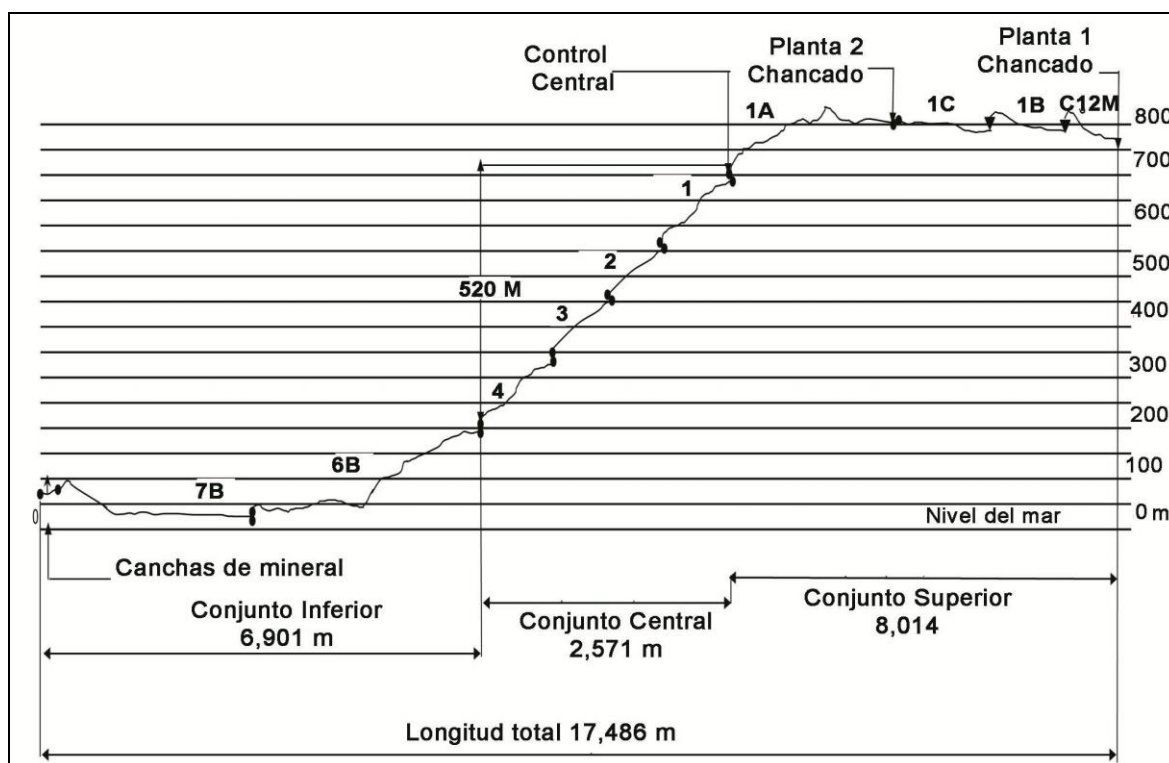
Perfil de elevación del sistema de fajas (Fuente: Referencia [2])
